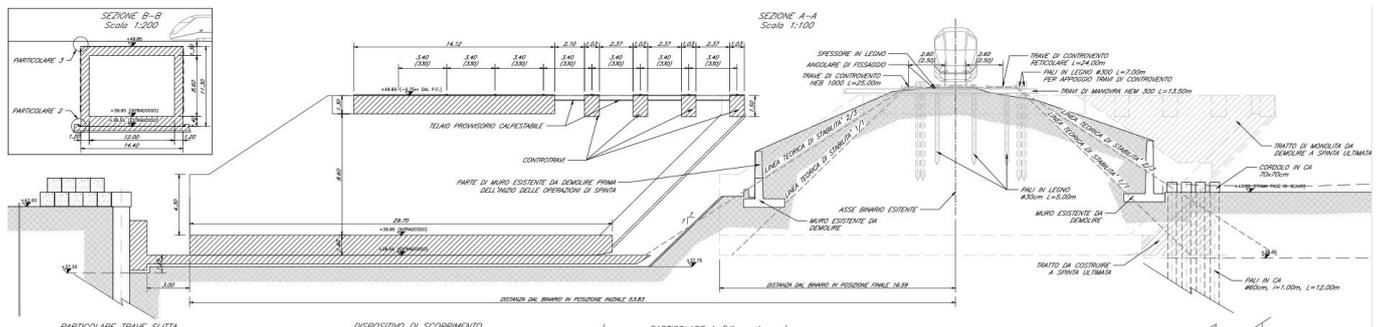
Sezione longitudinale dello schema costruttivo per il varo del monolite
